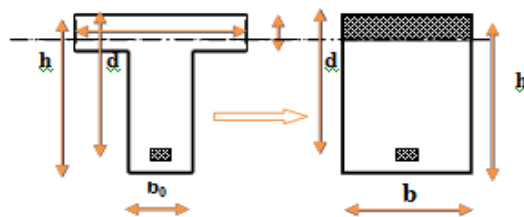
Coupe de Section Rectangulaire et Section en T.
